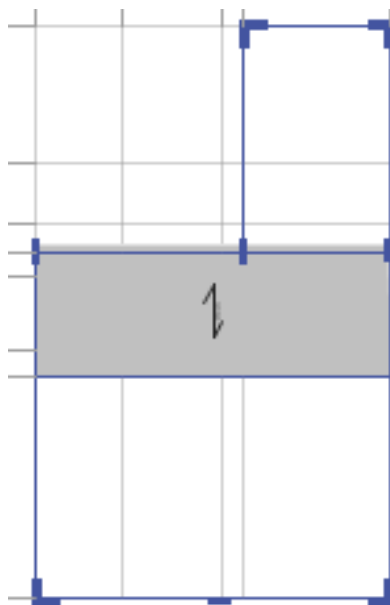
Asignación columnas, vigas y losas – módulo 2.
